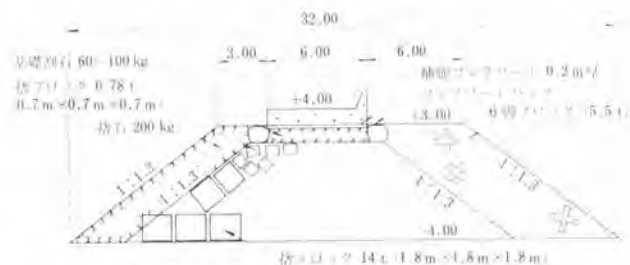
(C) ブロック堤標準断面図 (B区間 7.9 m)
